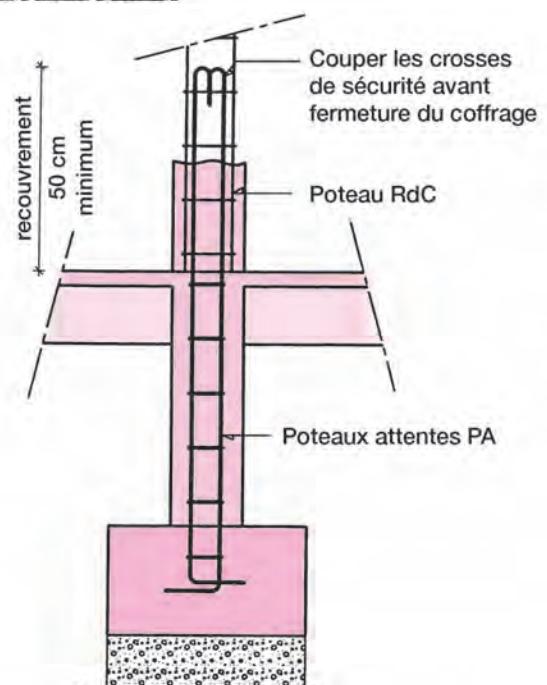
Poteau, raidisseur ou chaînage vertical ancré dans la semelle continue
